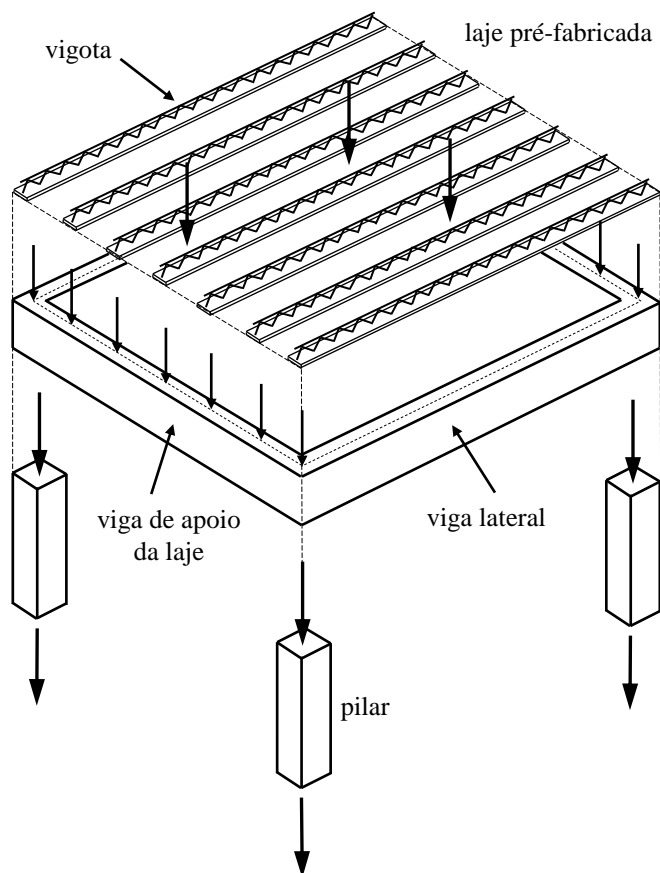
Caminhamento das cargas verticais no sistema estrutural tradicional com laje pré-fabricada.
